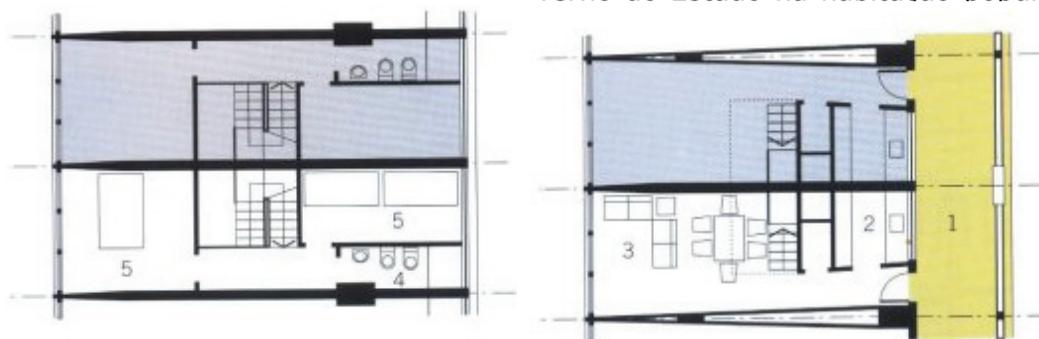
planta conjunto Pedregulho - RJ – apartamento duplex com dois dormitórios (pavimento superior e inferior) projetado por Affonso Eduardo Reidy em 1947.
